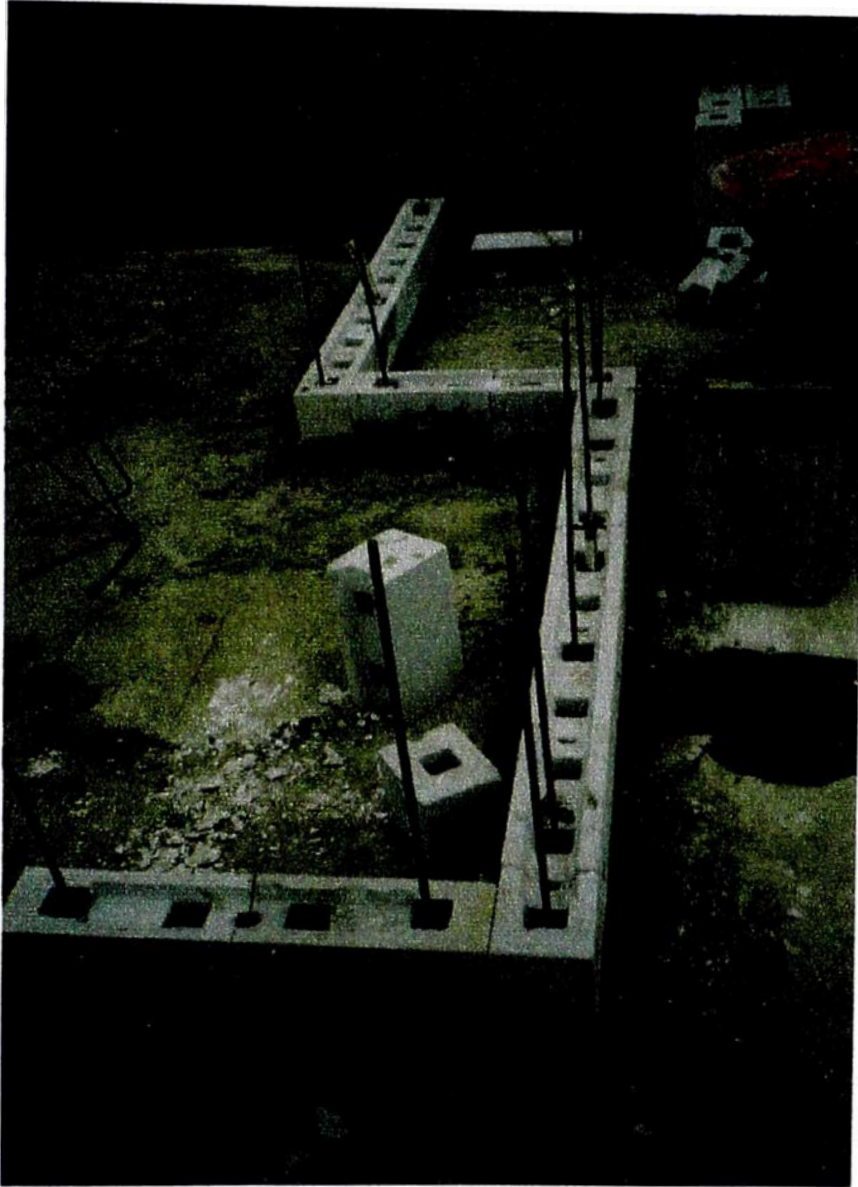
Asentado de la primera hilada y marca en los ladrillos y marcado de los ladrillos que llevan el refuerzo
